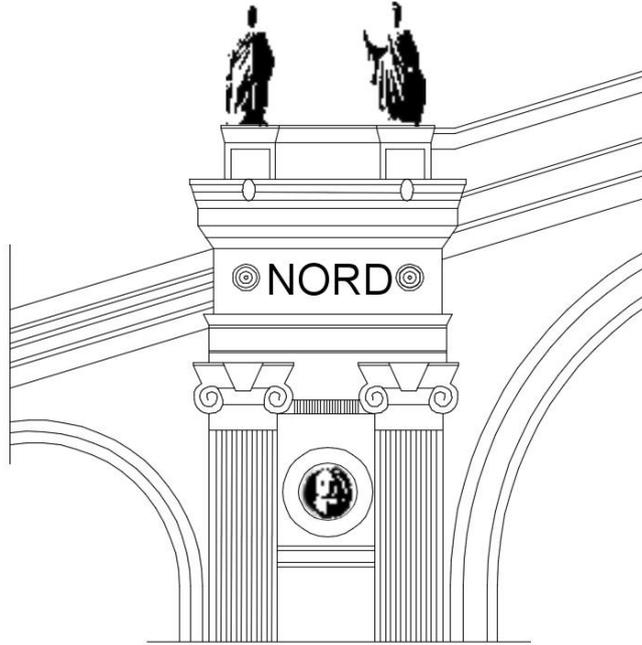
Gare Du Nord. Fachada. Detalle. Año 2017. Fuente: Propia.
